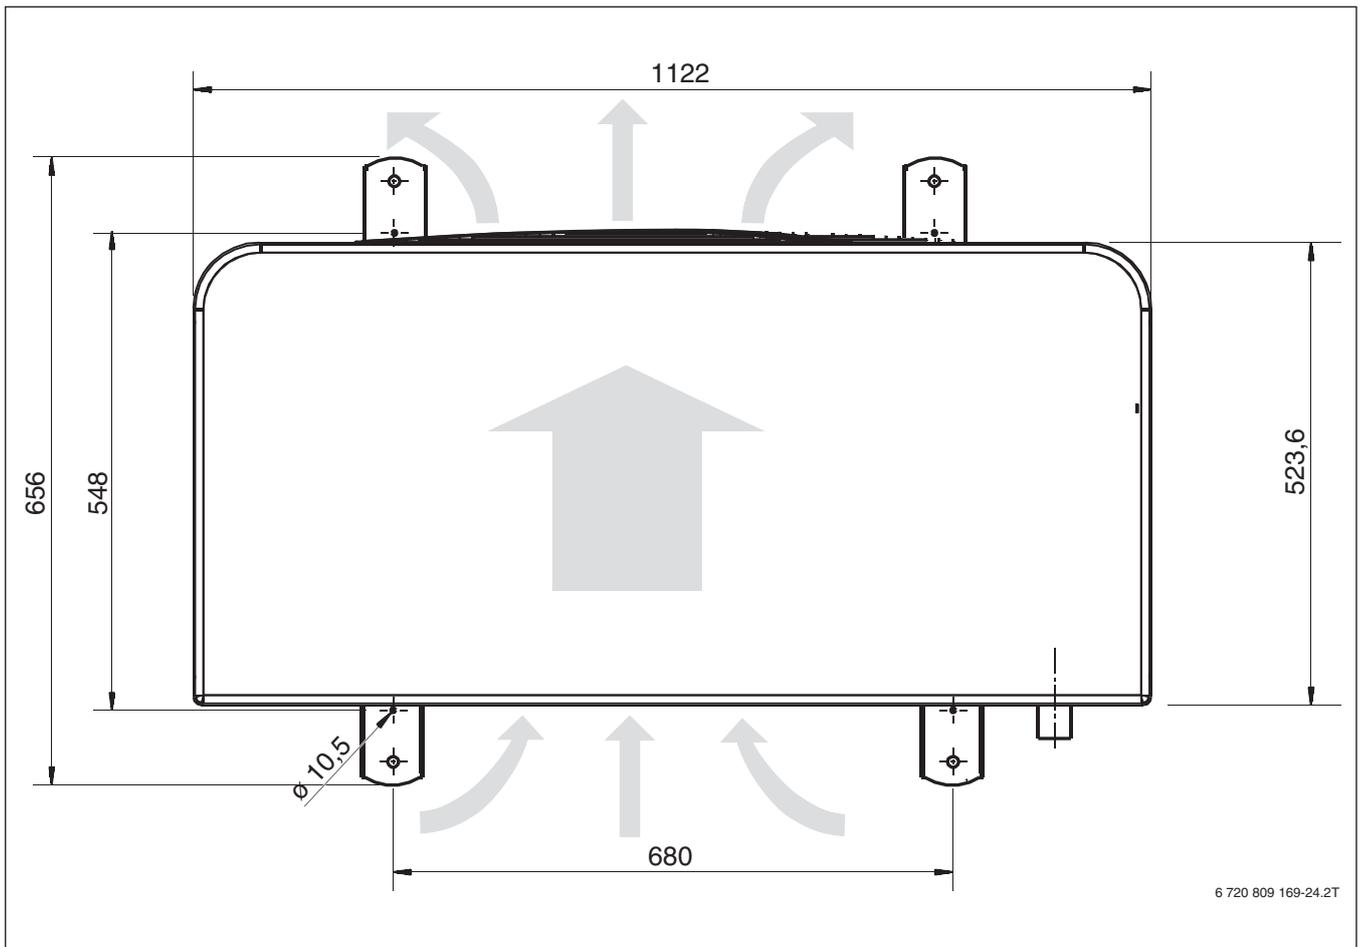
Abmessungen der Außeneinheit ODU W11/W14, Draufsicht
